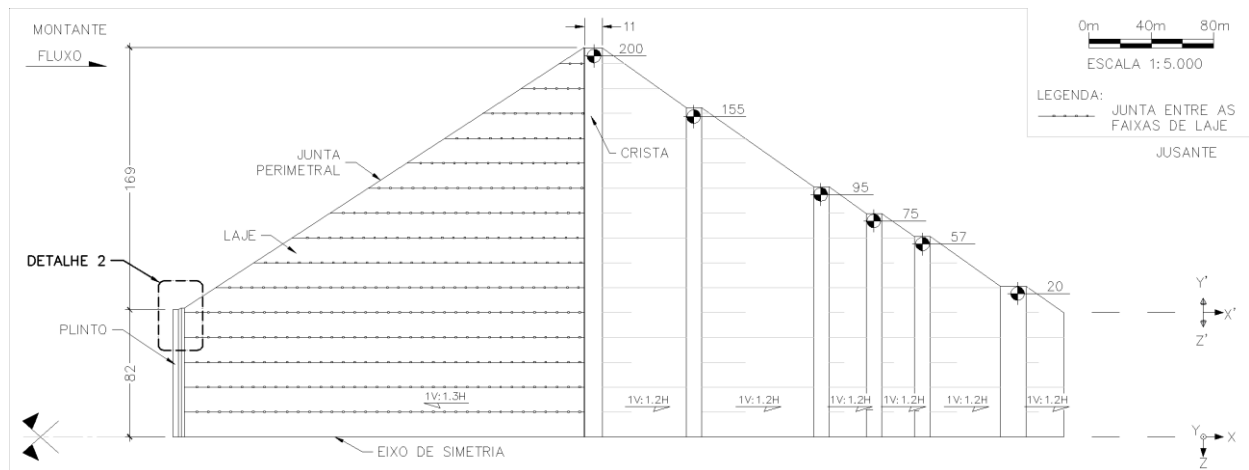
Vista em planta do modelo tridimensional com posição do Detalhe 2.
